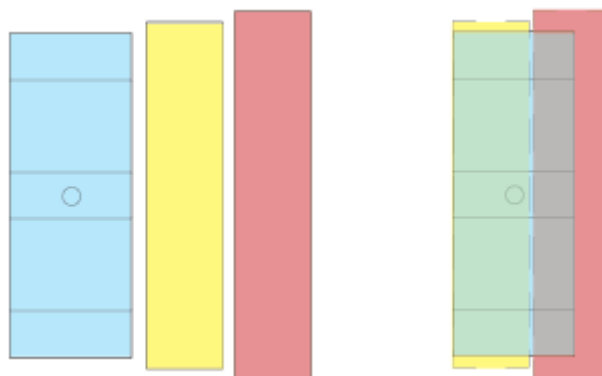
Gary Chang. *Planta baixa módulo 6*. Japão. Fonte: da autora
